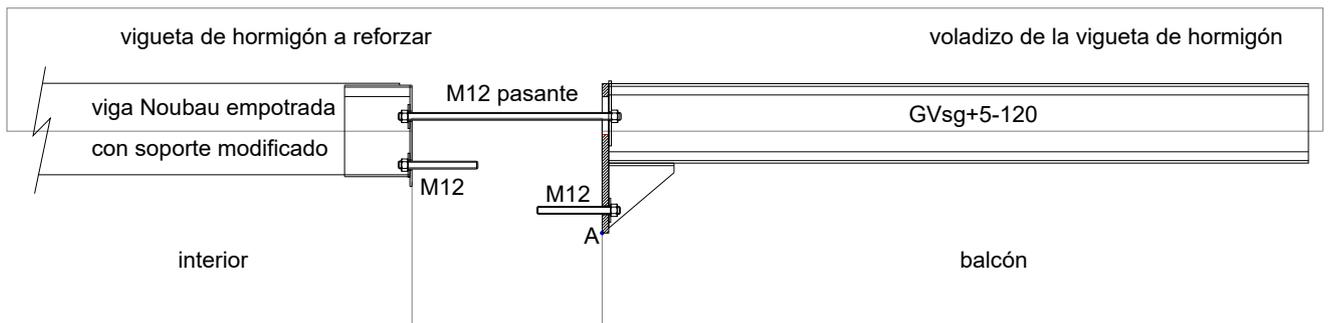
Detalle del soporte interior para refuerzo de voladizo con contrapeso
